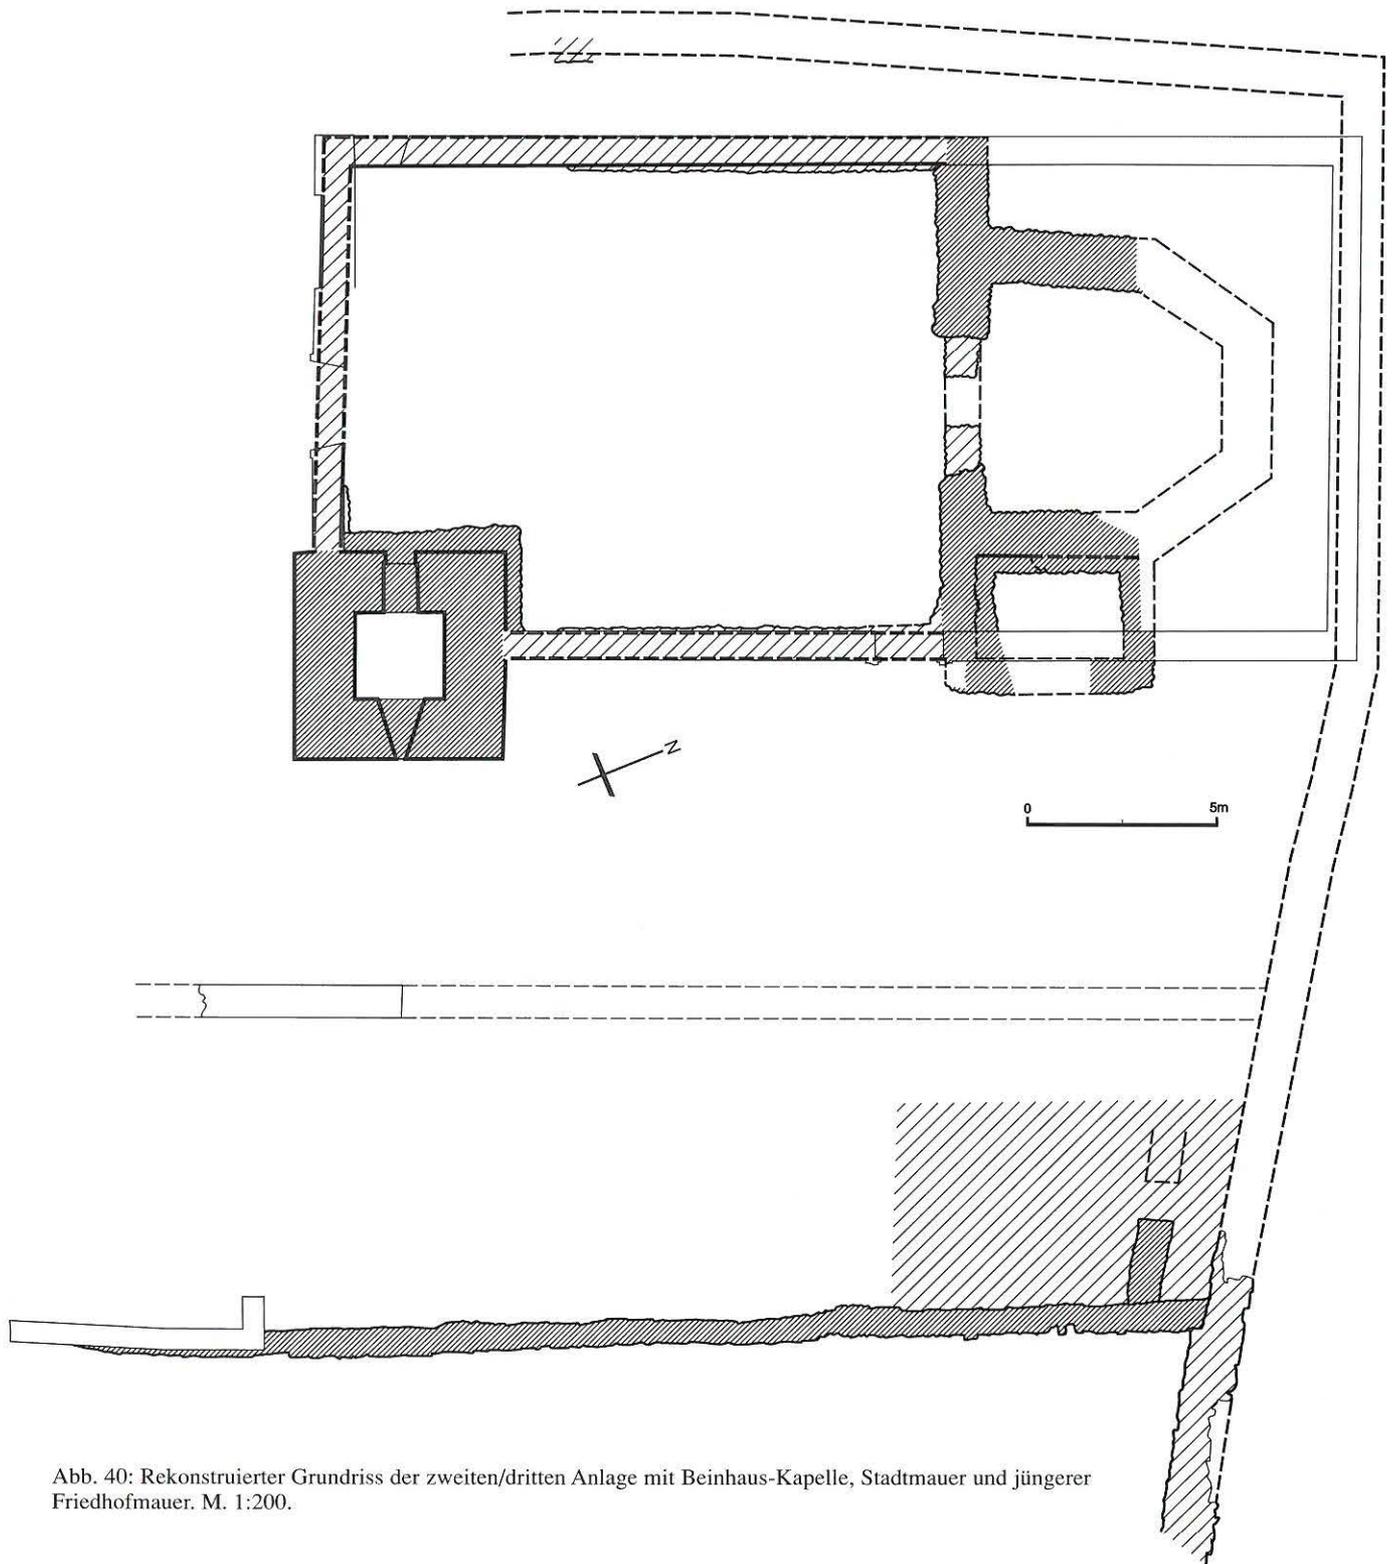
Rekonstruierter Grundriss der zweiten/dritten Anlage mit Beinhaus-Kapelle, Stadtmauer und jüngerer Friedhofsmauer. M. 1:200.
